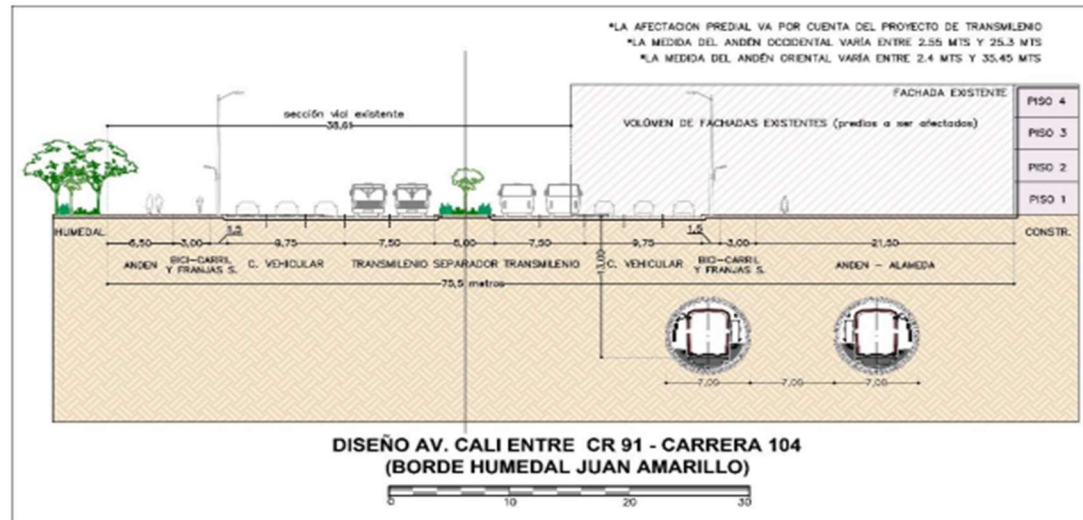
Perfil vial definido para Av. Cali (entre cra. 91 y cra. 104).
